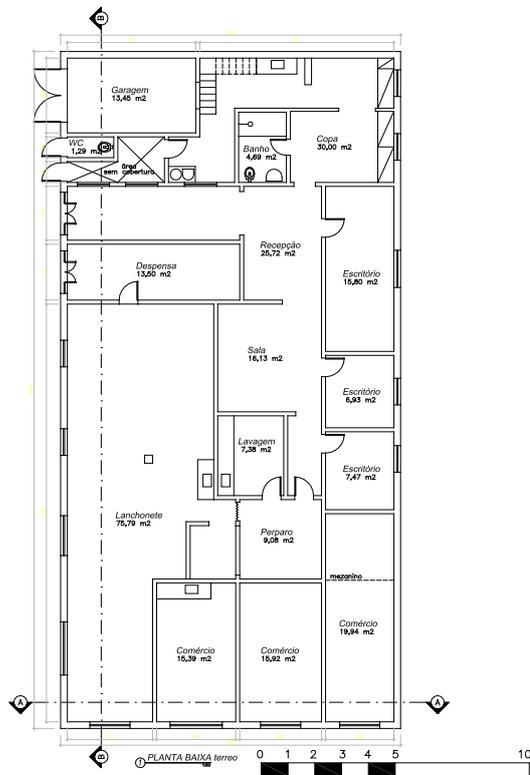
Planta pavimento térreo - Casa Maria Lilian Nunes Barreto
